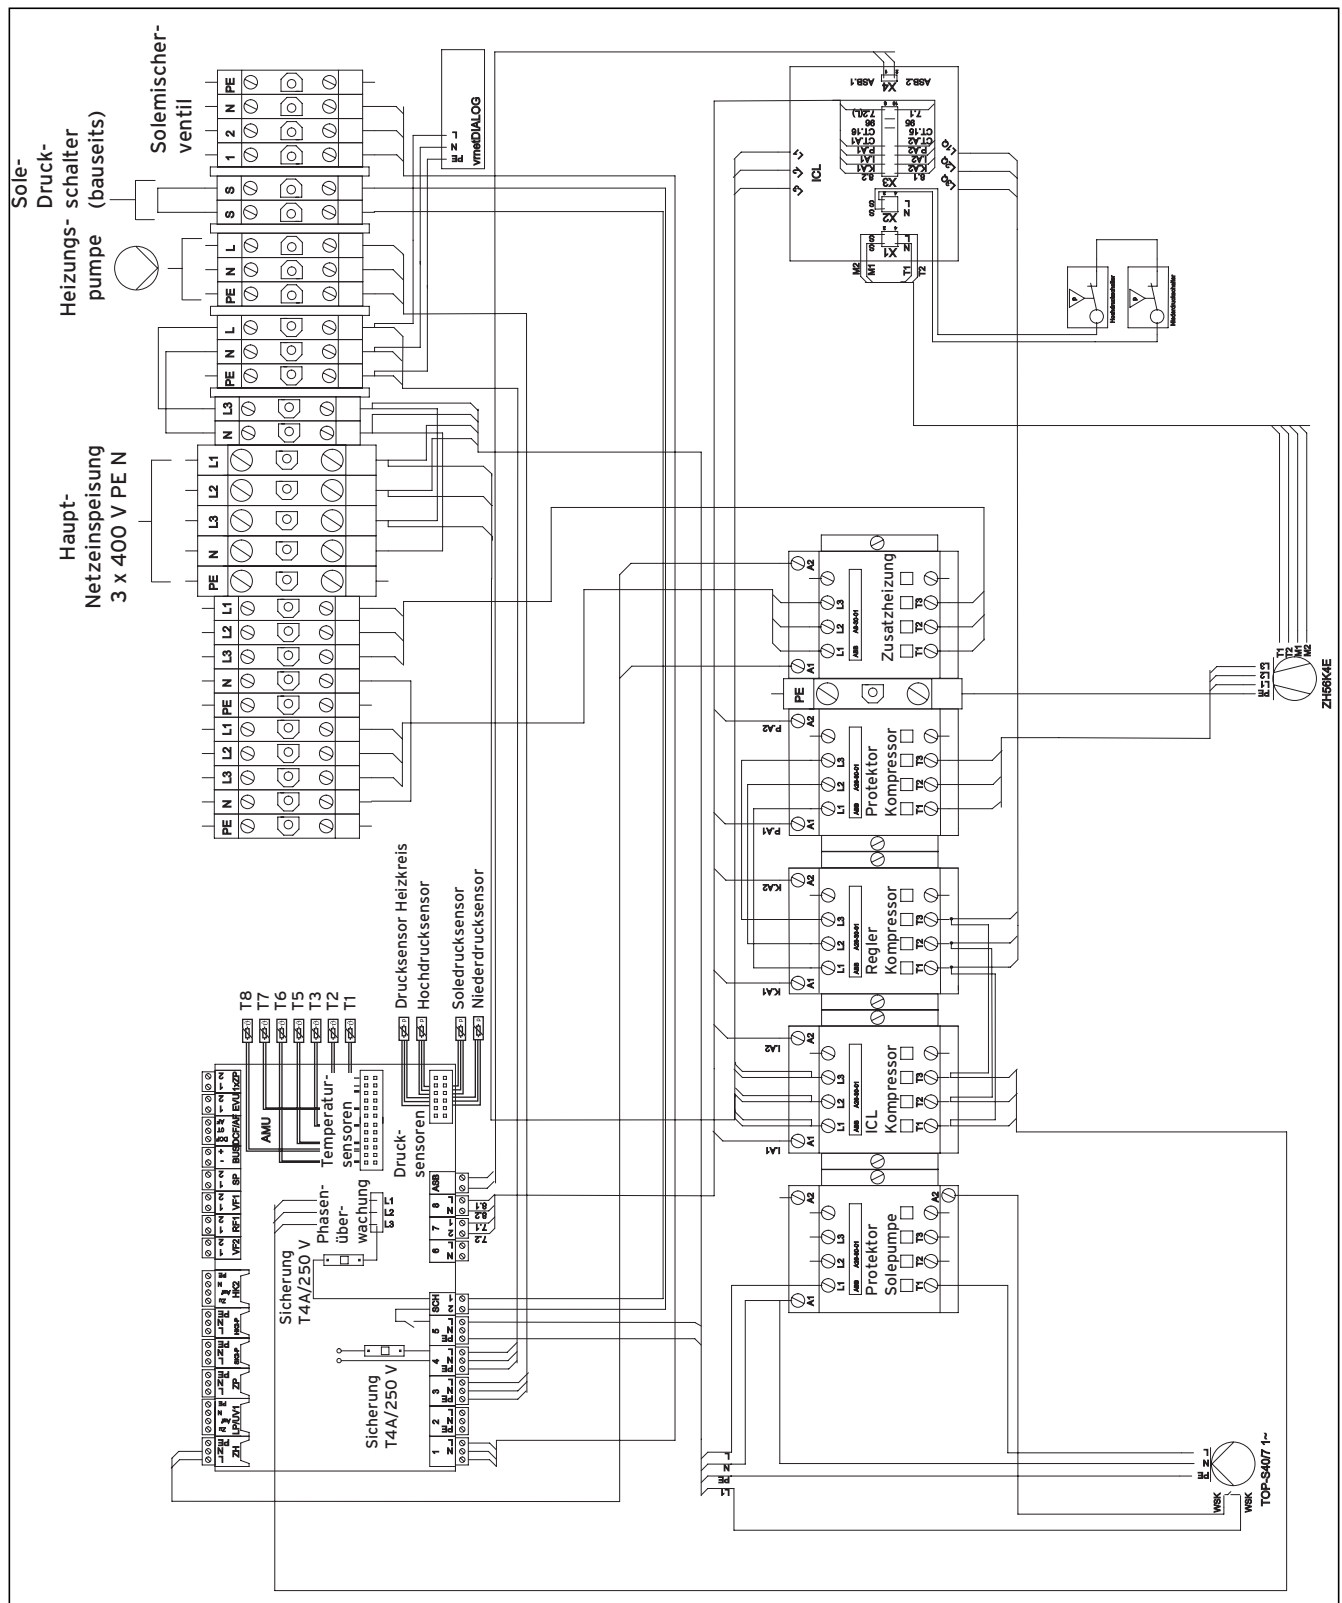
, Anhang, Stromlaufplan VWS 220/VWS 300
